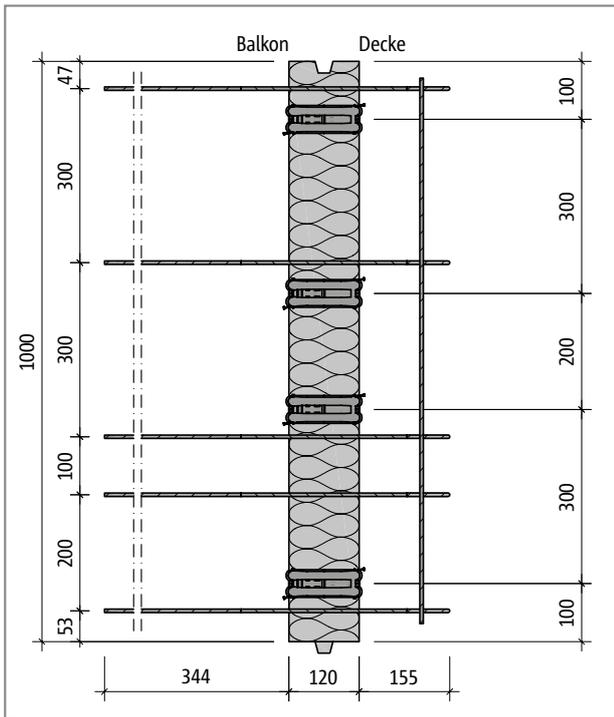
Schöck Isokorb® Typ QXT10: Produktgrundriss
